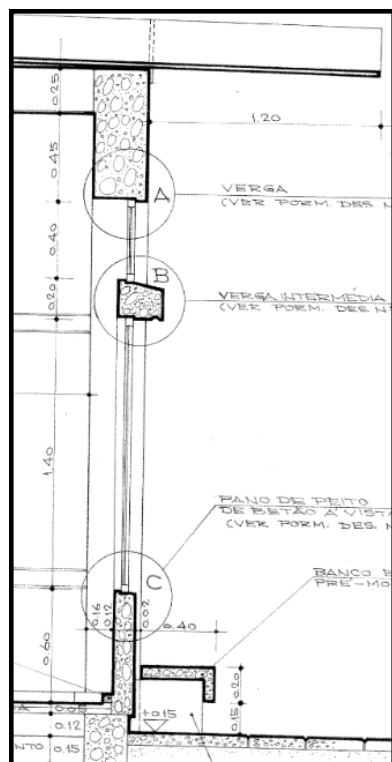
Corte da fachada tipo de sala. (P.E 1)
